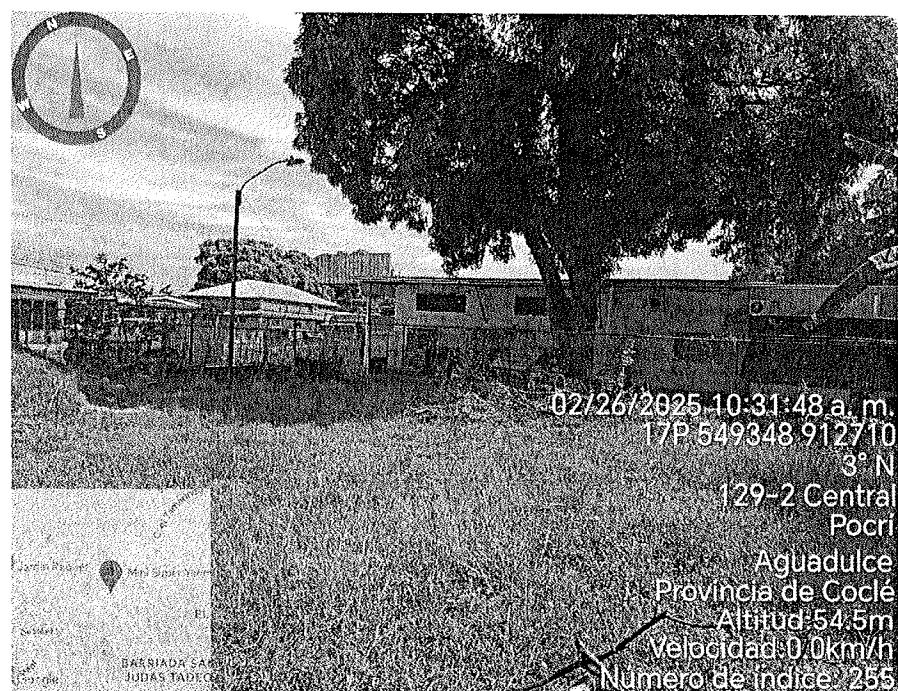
, 2 y 3 Área propuesta para el desarrollo del proyecto.
